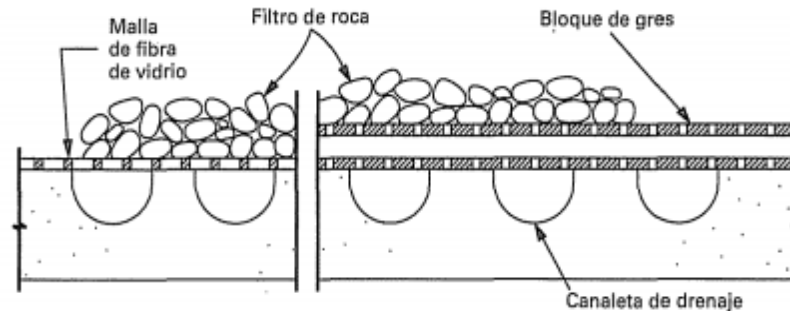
3 Sistemas de drenaje inferior para filtros de piedra.
